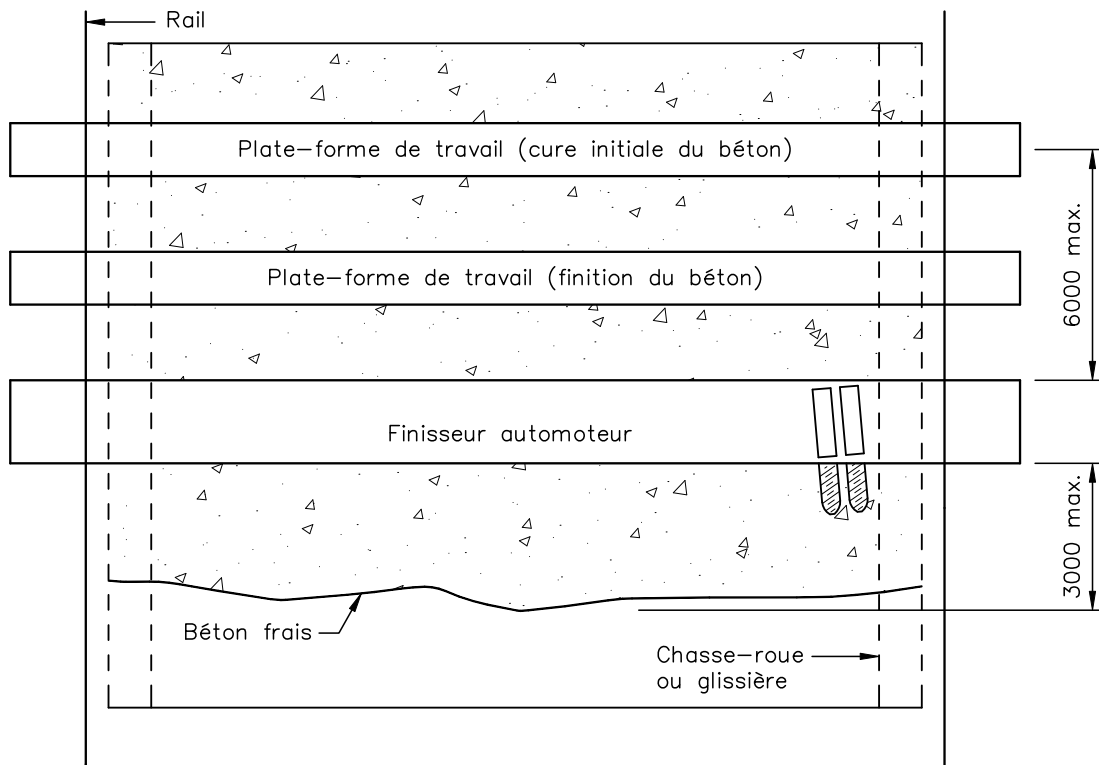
Disposition du finisseur automoteur et des plates-formes de travail
